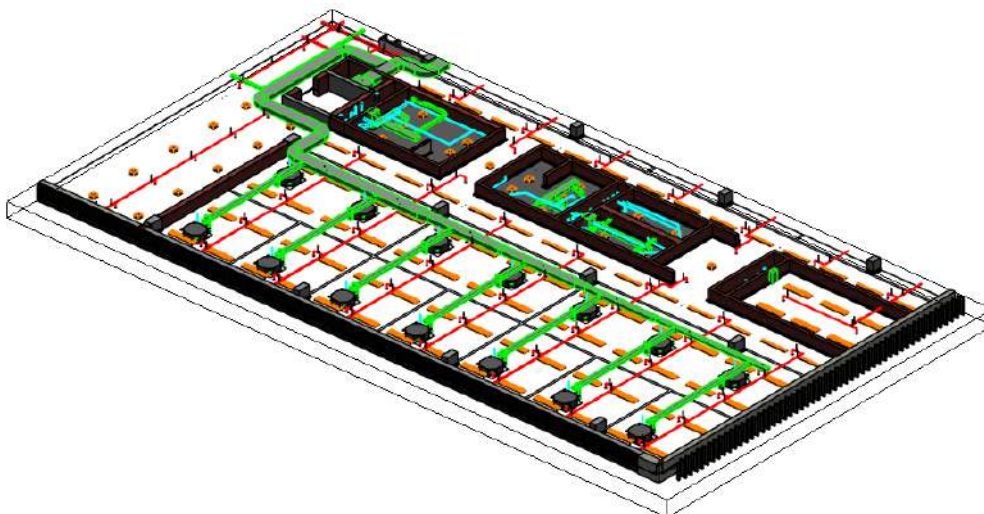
Trecho ampliado Pavimento Tipo (compatibilização) - Modelo Federado - PJSO – Sobradinho
